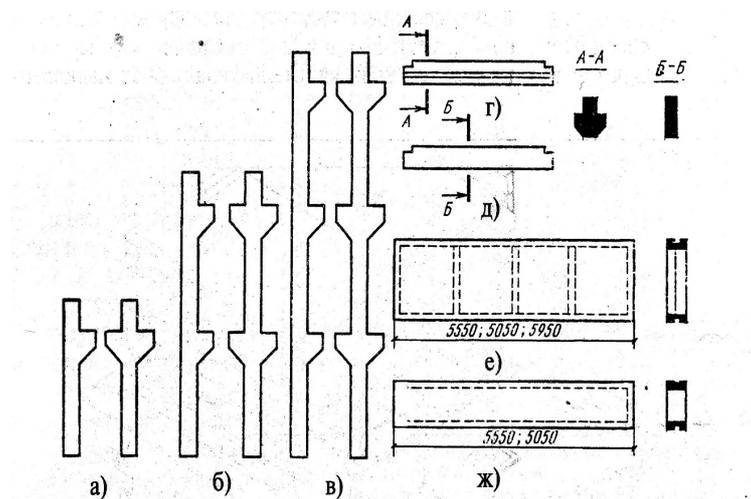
Унифицированные сборные элементы балочного железобетонного каркаса колонны:
